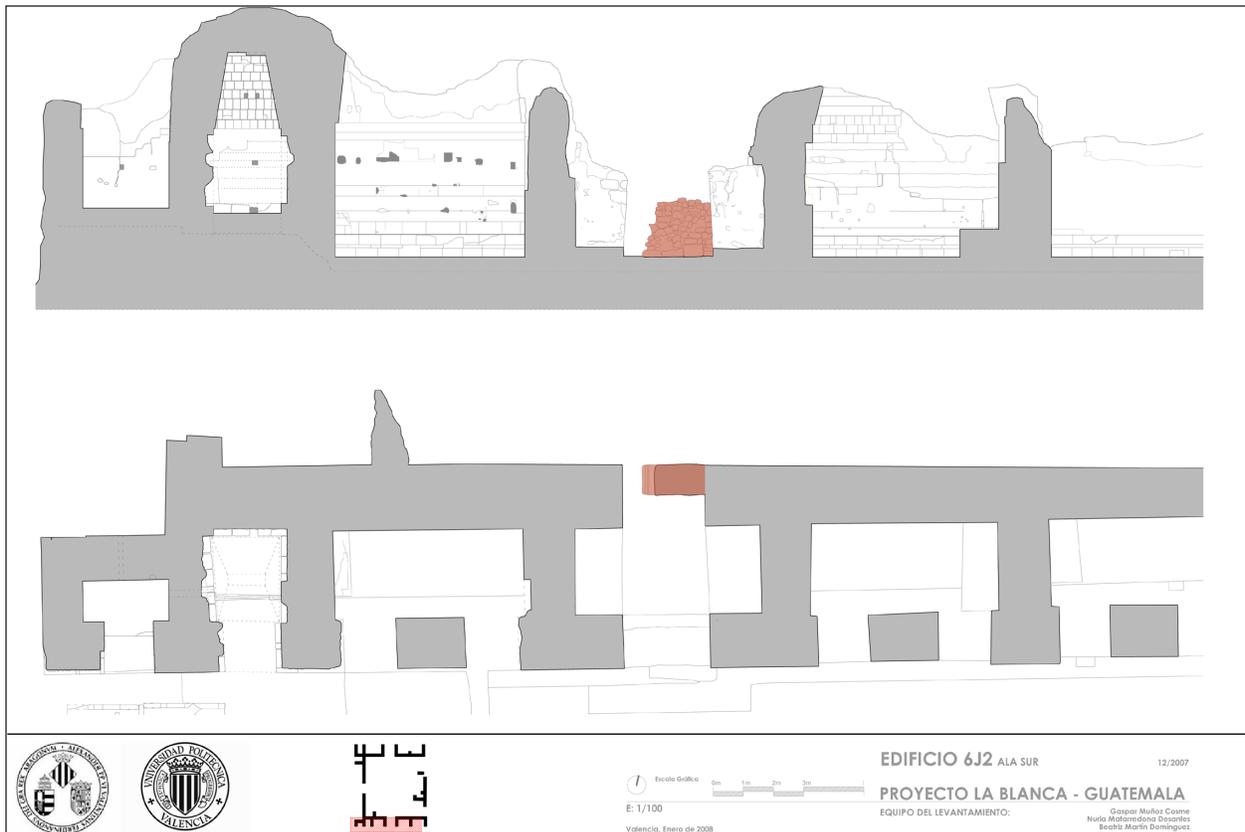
Planta y sección del Ala Sur del Palacio 6J2, en la que se aprecia el muro de cierre levantado en el Cuarto 3 a finales del Clásico Terminal (levantamiento Proyecto La Blanca 2007).
